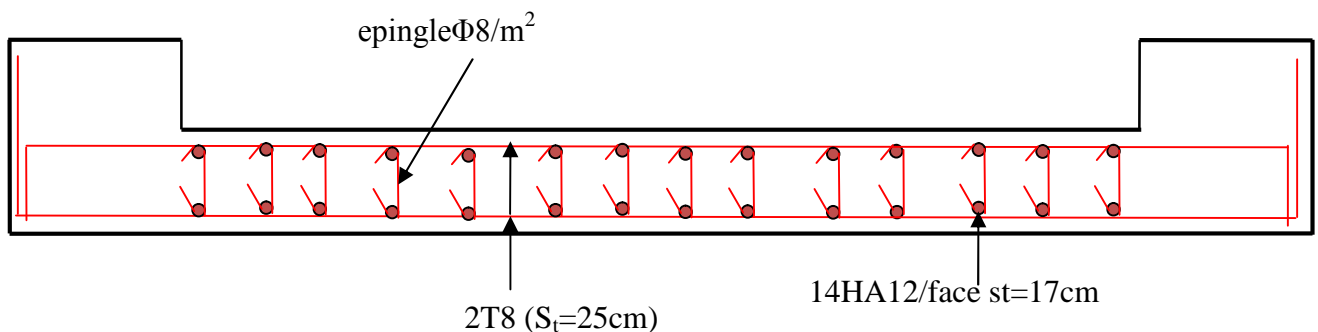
Schéma de ferrailage du voile Vy2 RDC
